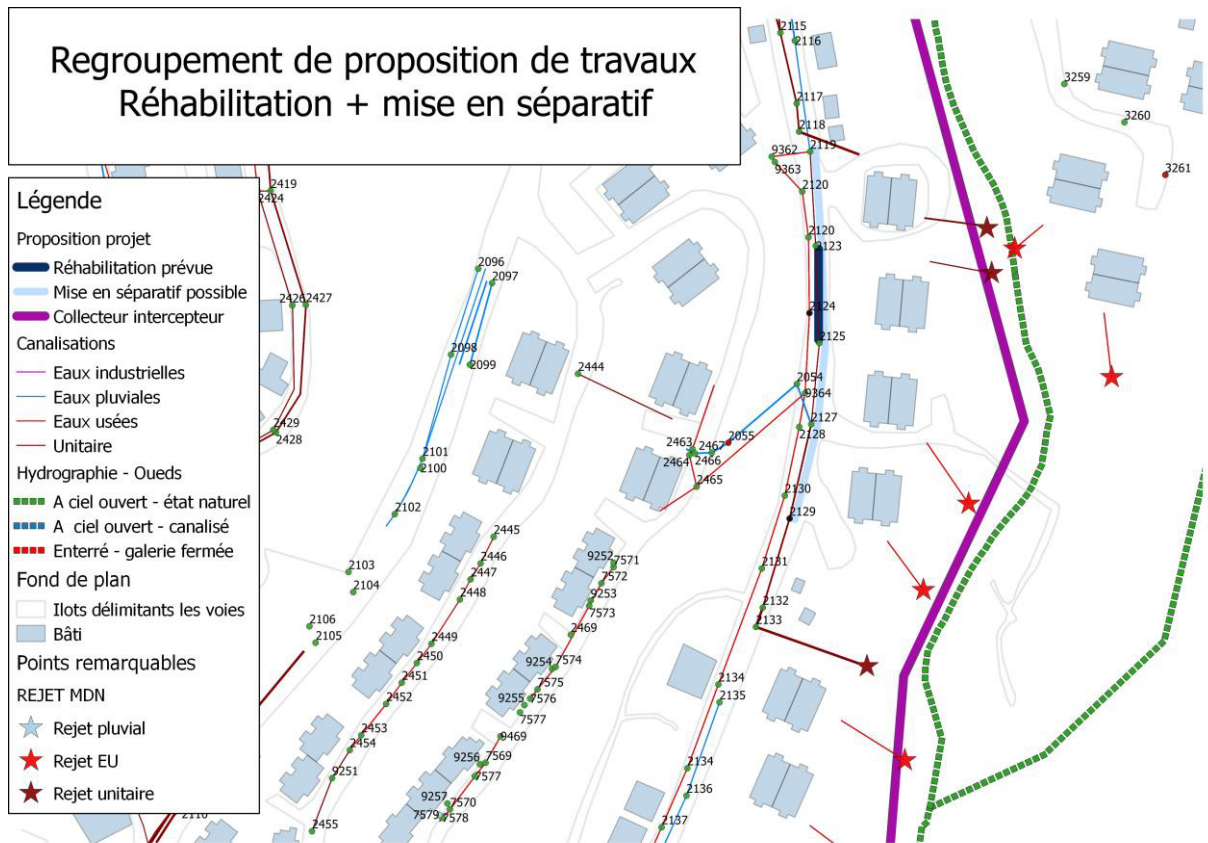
Situation de regroupement de travaux sur Sidi Ahmed
